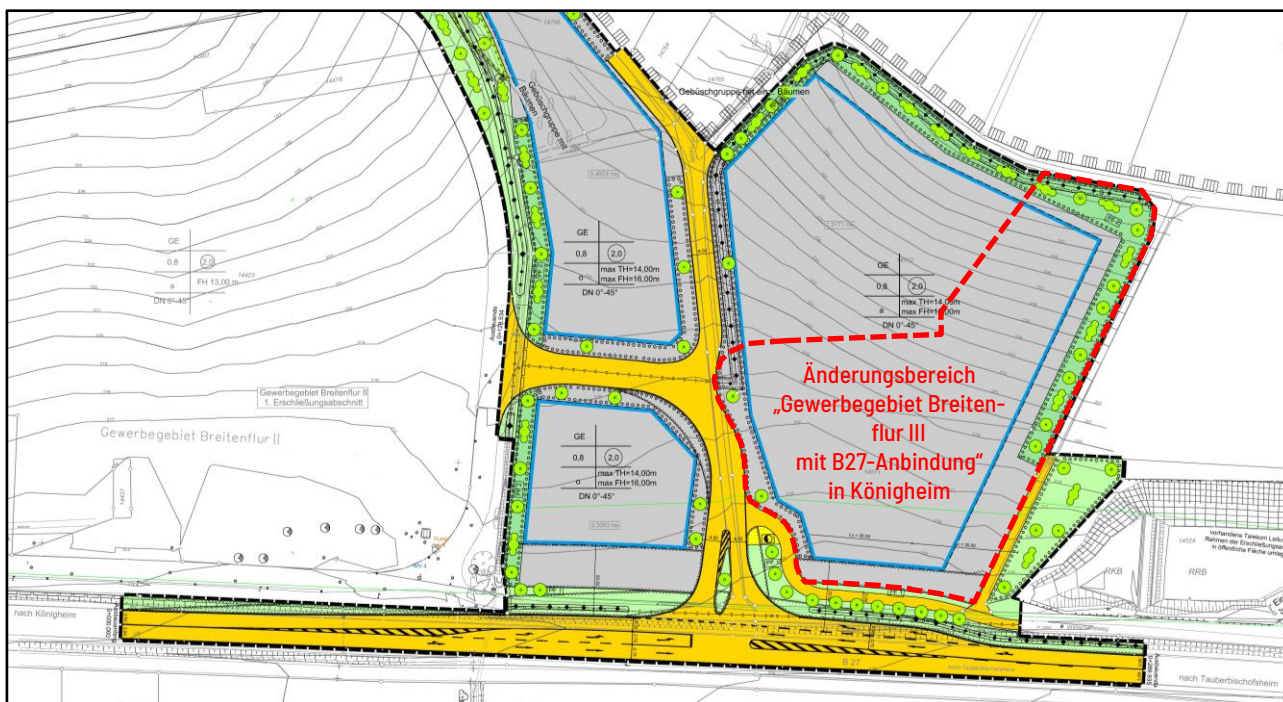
Auszug rechtskräftiger Bebauungsplan „Gewerbegebiet Breitenflur III mit B27-Anbindung“ mit Darstellung des Planbereichs
